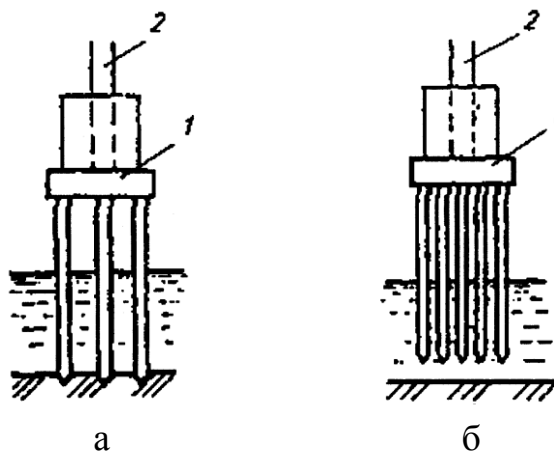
Свайные фундаменты: *а* – сваи стойки; *б* – висячие сваи:
